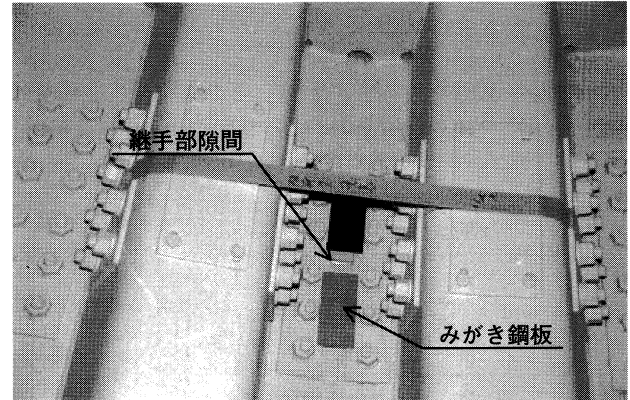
格点31 みがき鋼板設置状況 (継手あり・隙間あり)
